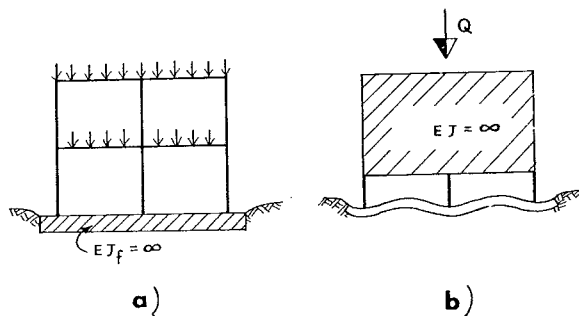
Situazioni limite di rigidezza relativa fondazione-s sovrastruttura. a) sovrastruttura infinitamente meno rigida della fondazione; b) sovrastruttura infinitamente più rigida della fondazione.
